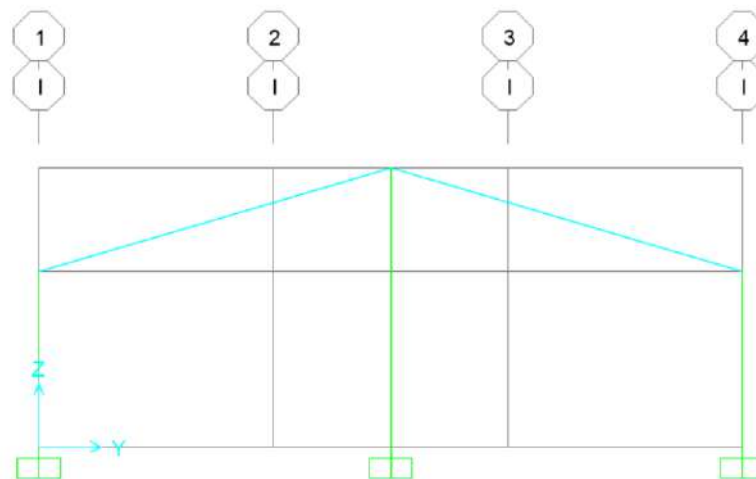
Pemodelan Struktur Tampak Potongan Memanjang
